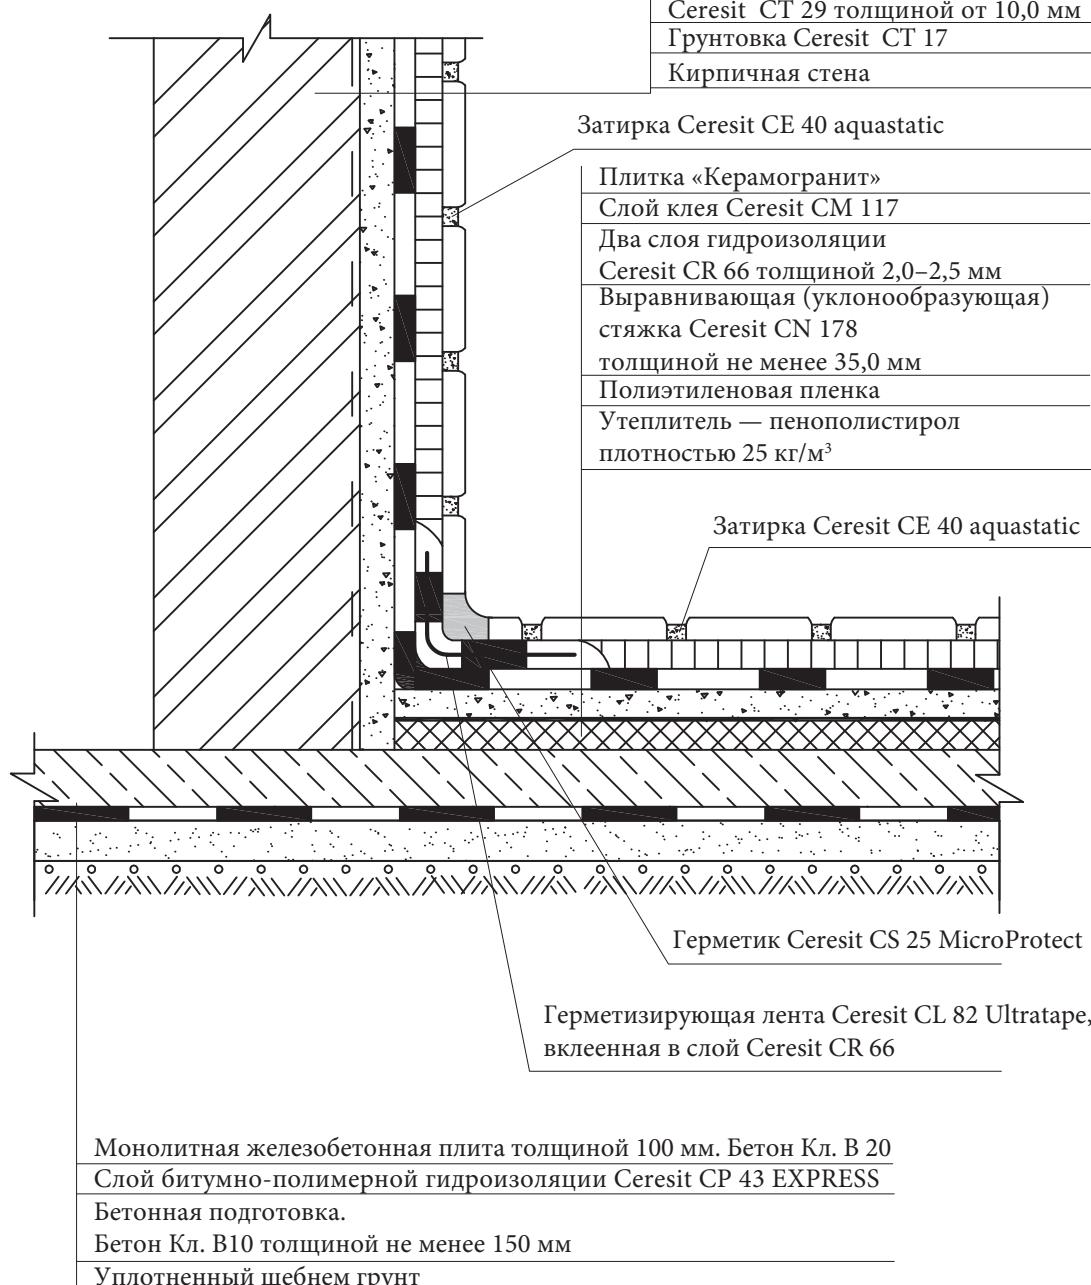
Конструкция системы гидроизоляции бытовых и производственных душевых помещений, расположенных на грунтовом основании
